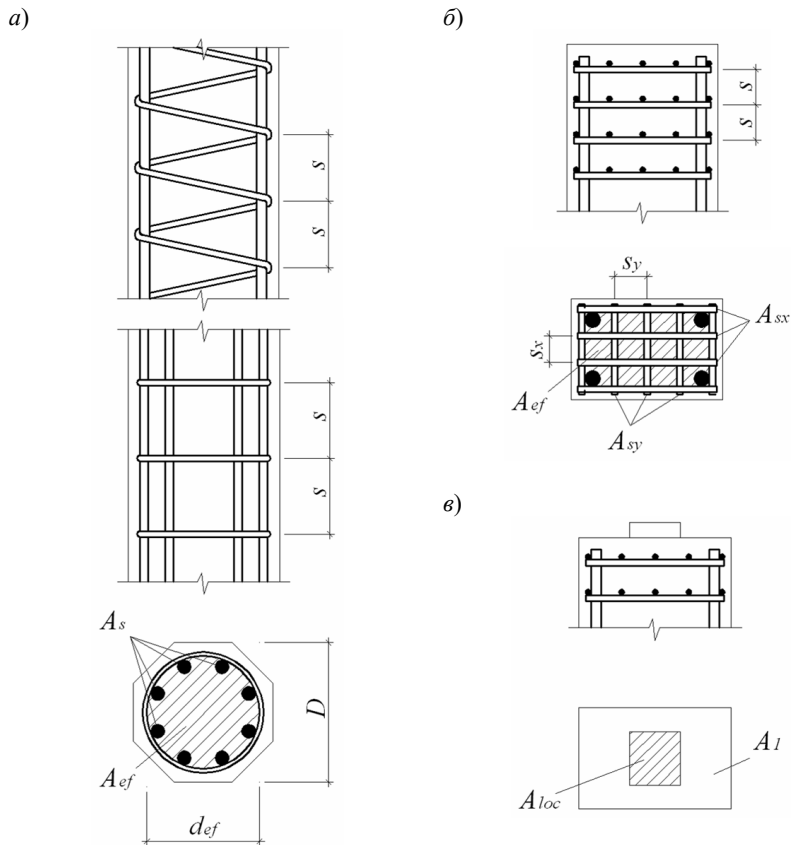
Сжатые элементы усиленные косвенным армированием:
